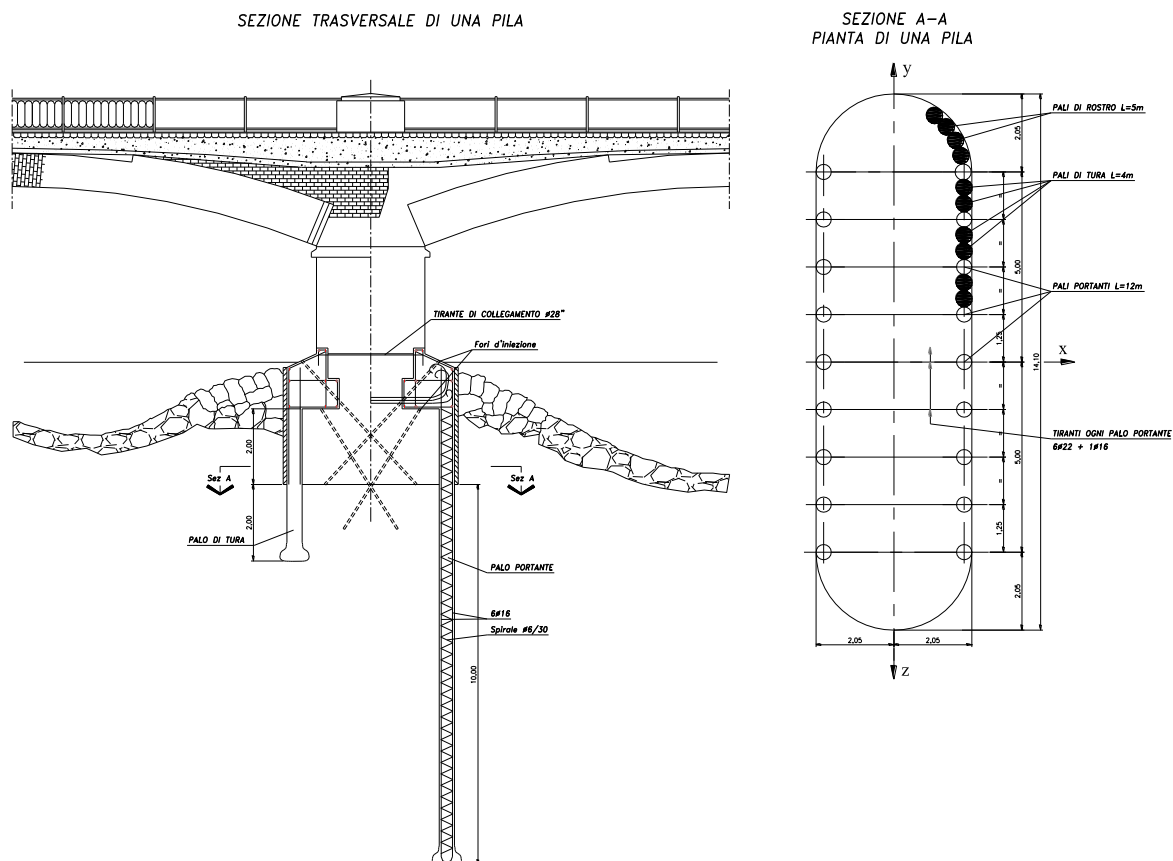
Lavori di rinforzo delle fondazioni delle pile (1947)
